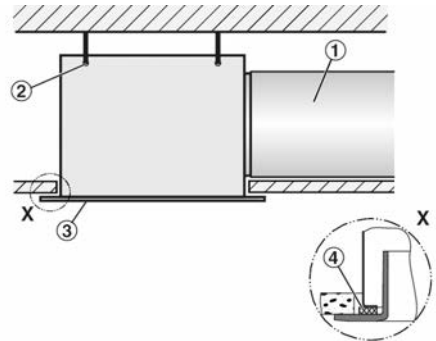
Deckenbündiger Einbau mit quadratischem Anschlusskasten
